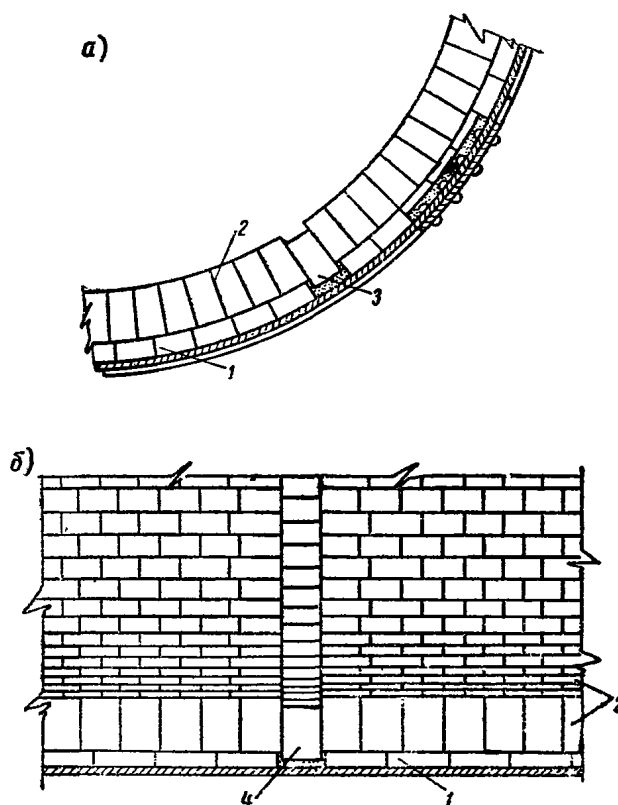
Кладка огнеупора по шамотной теплоизоляционной лещадке
